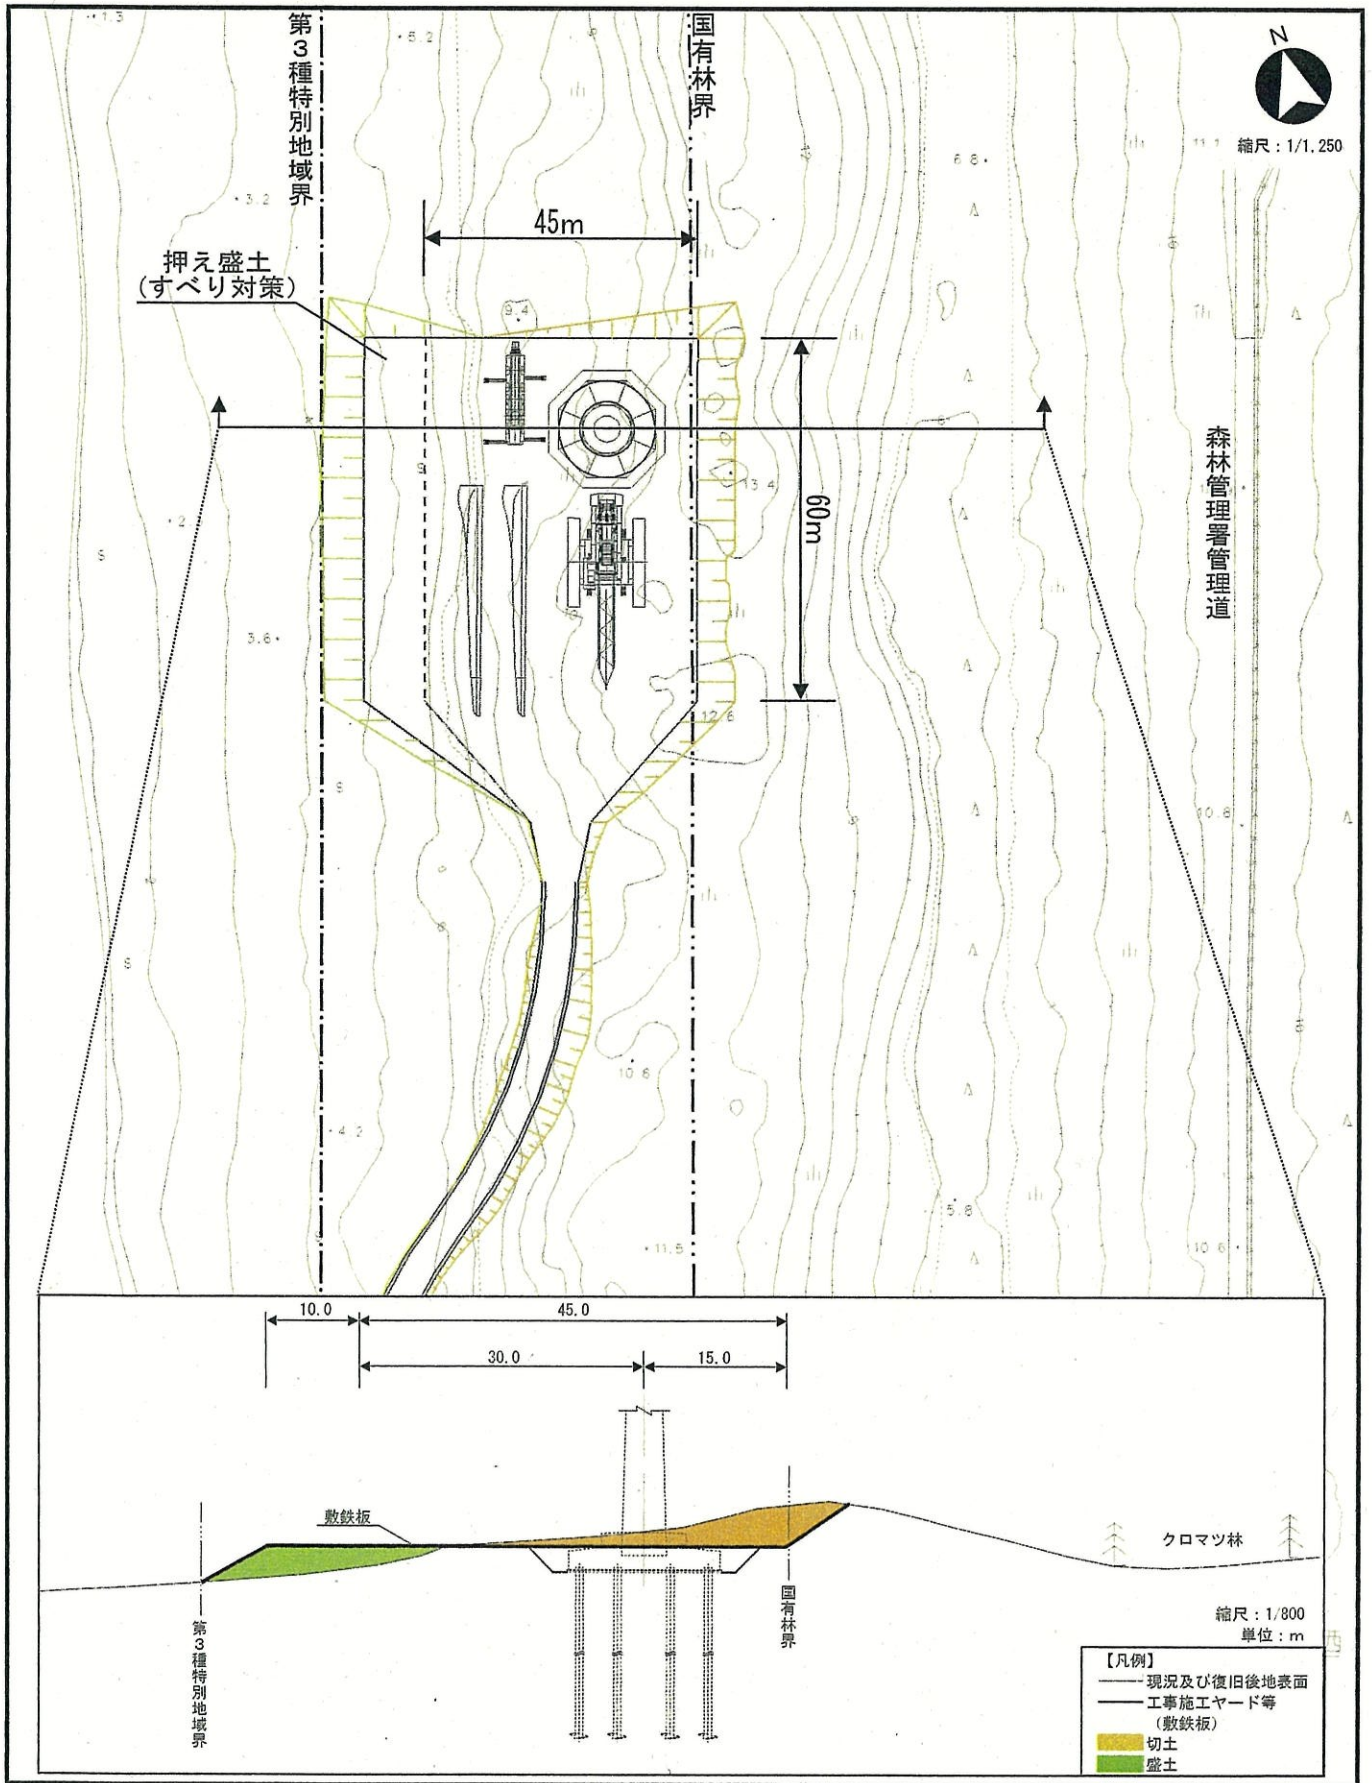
(2) 仮設ヤード等平面図 (設置時) (1号機)
